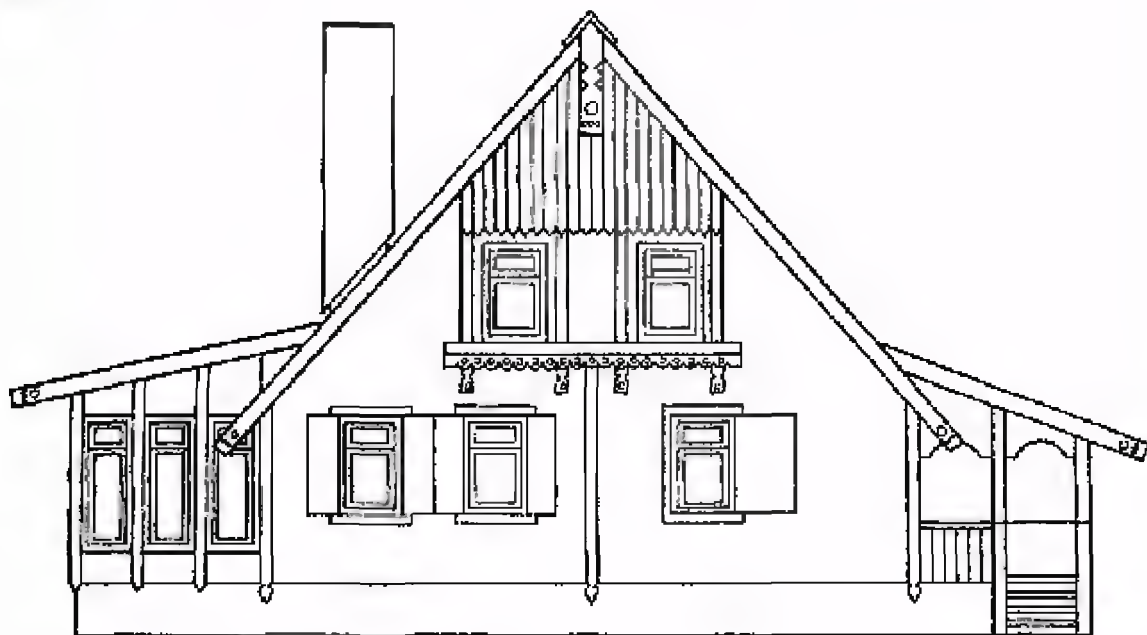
Вариант оформления фасада пятикомнатного жилого дома деревянно-панельной конструкции серии 115
